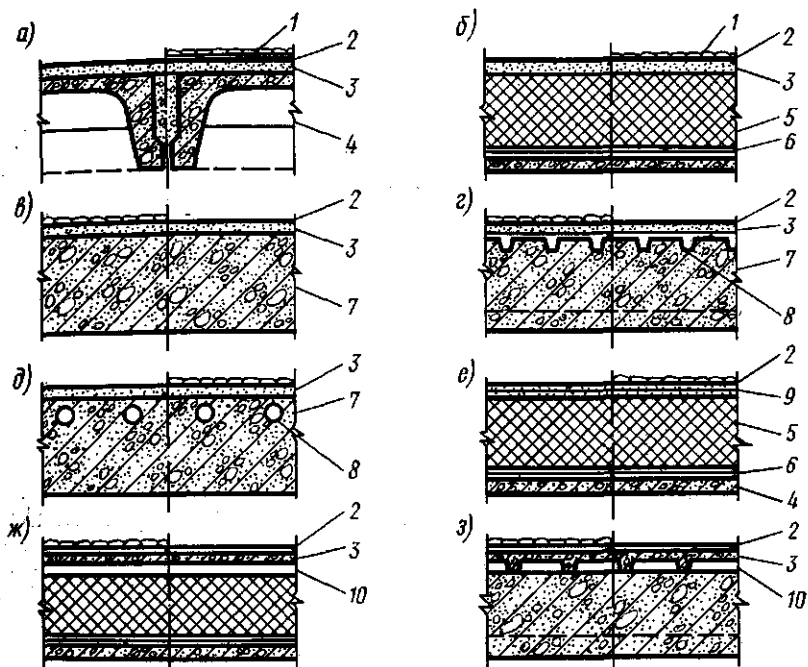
Основные типы покрытий с железобетонными плитами и рулонными кровлями:
